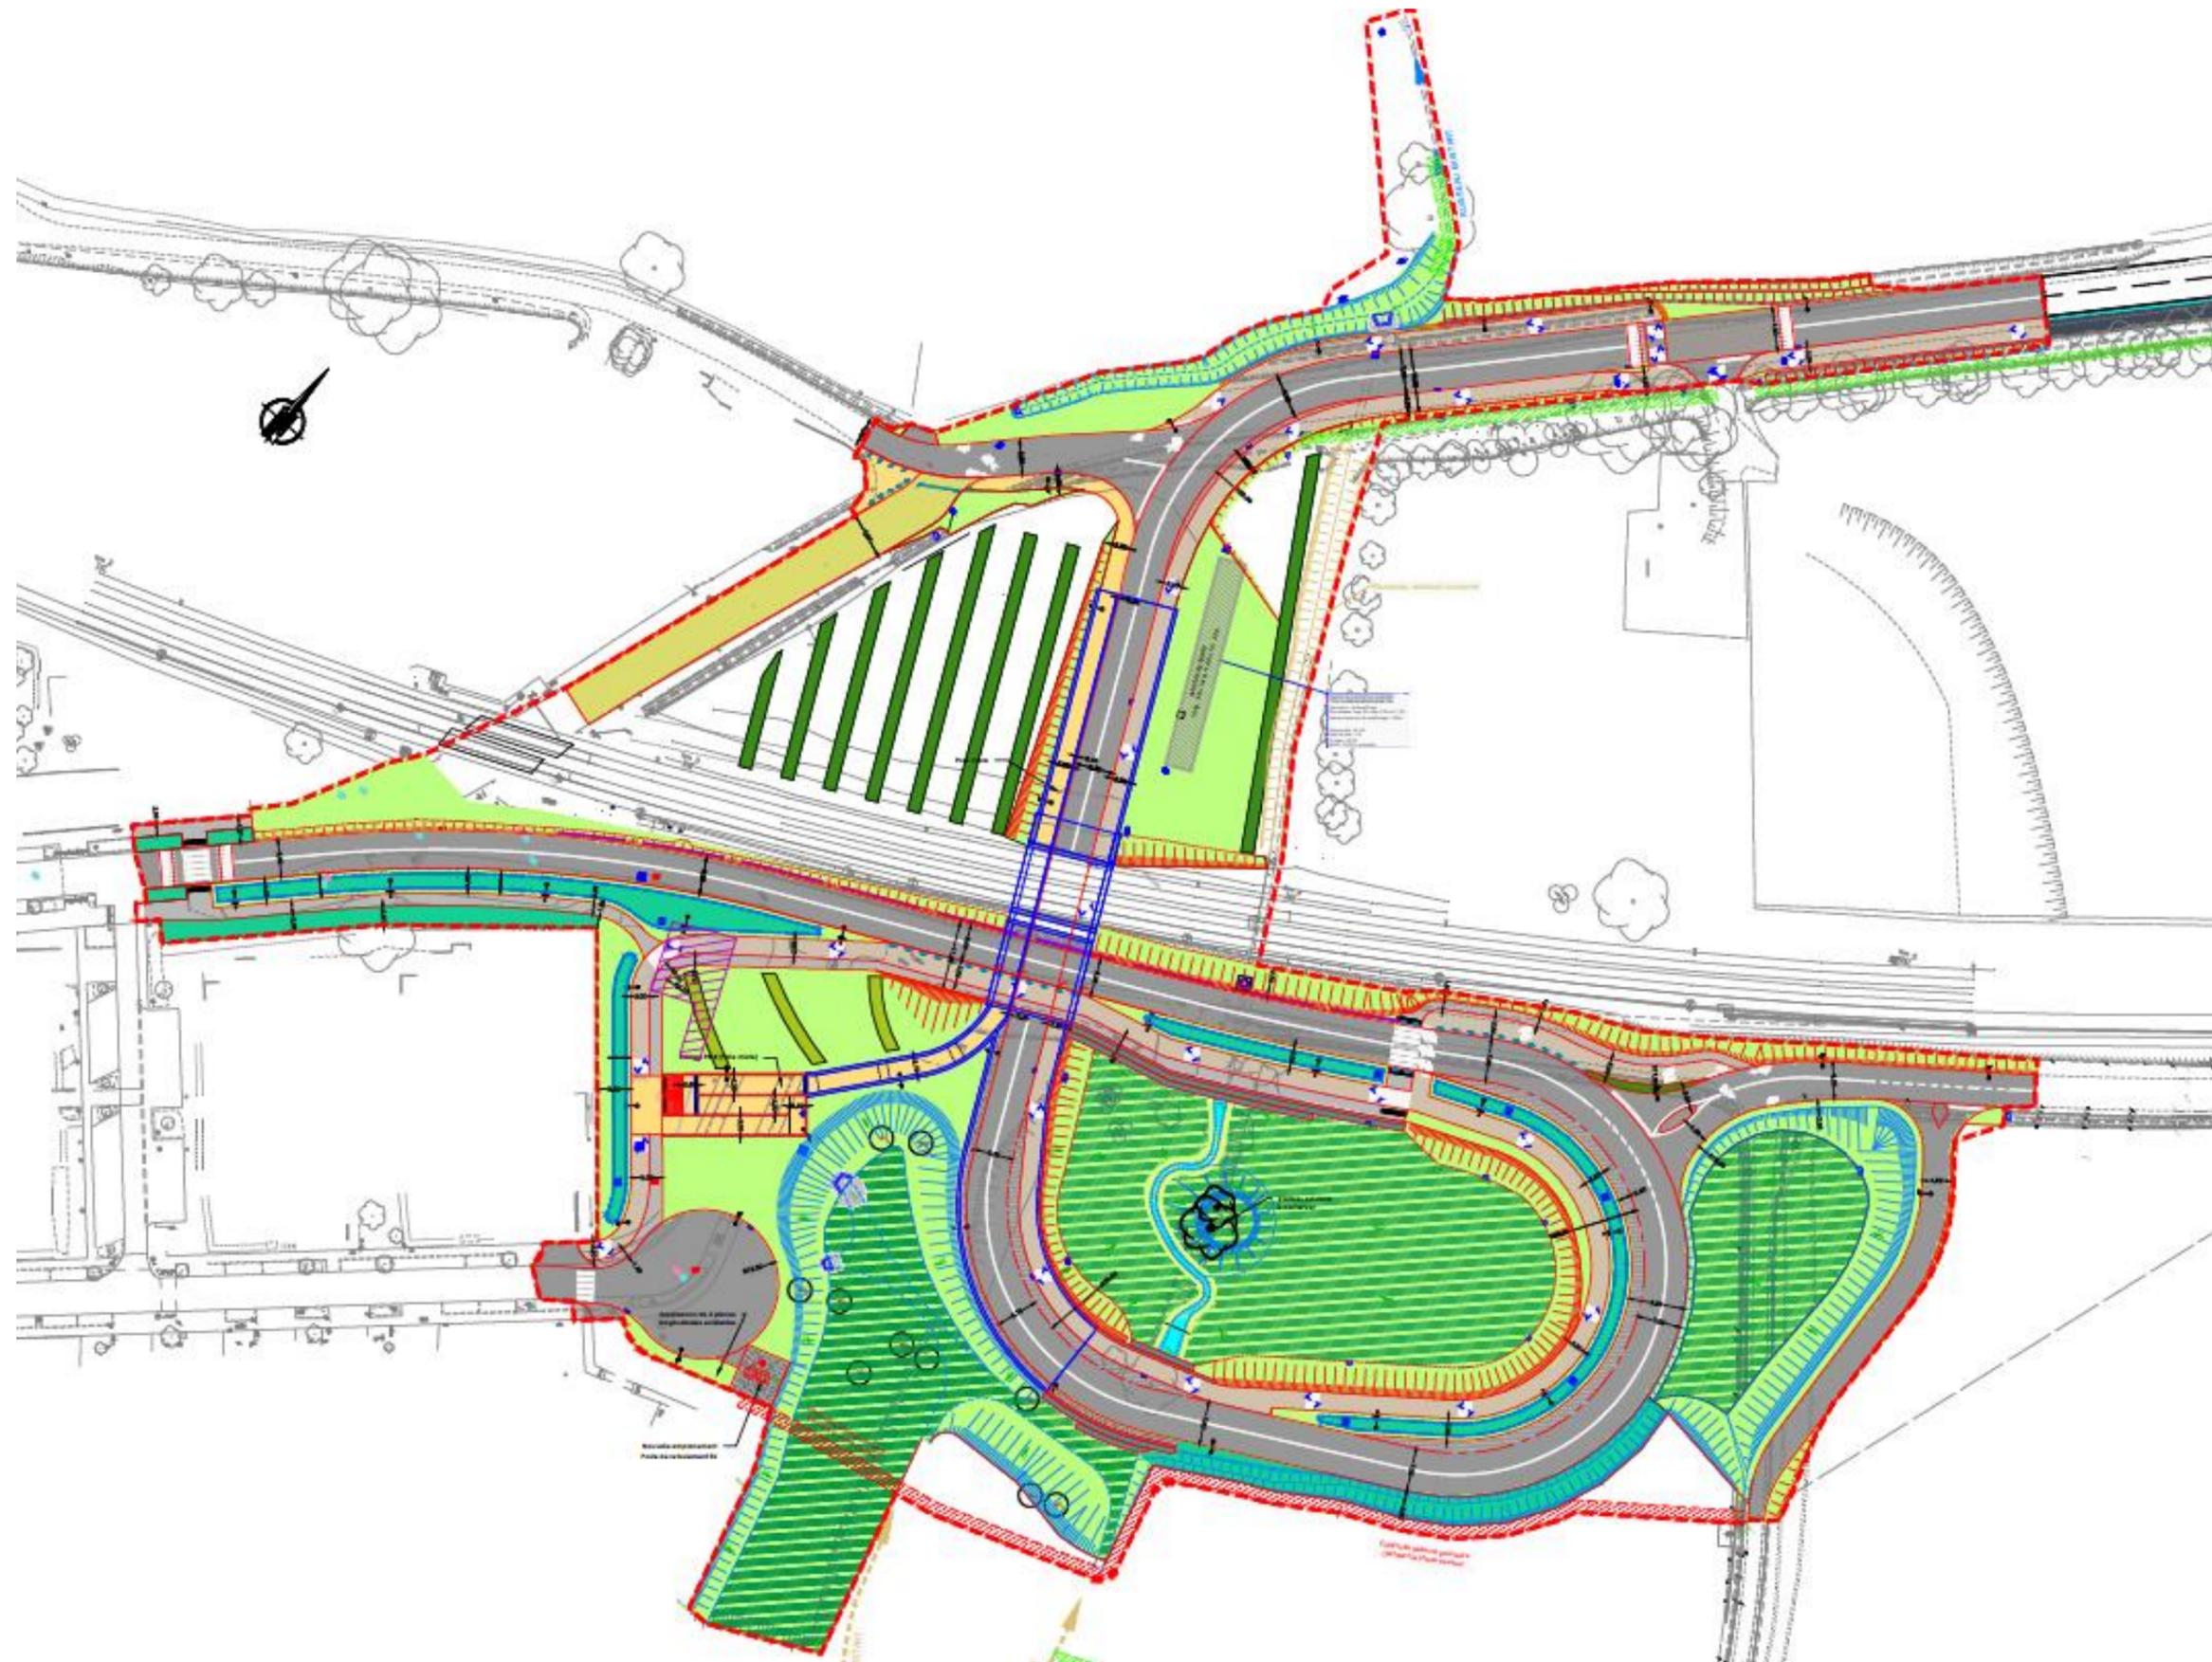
PLAN DE MASSE DU PROJET 1/250EME
